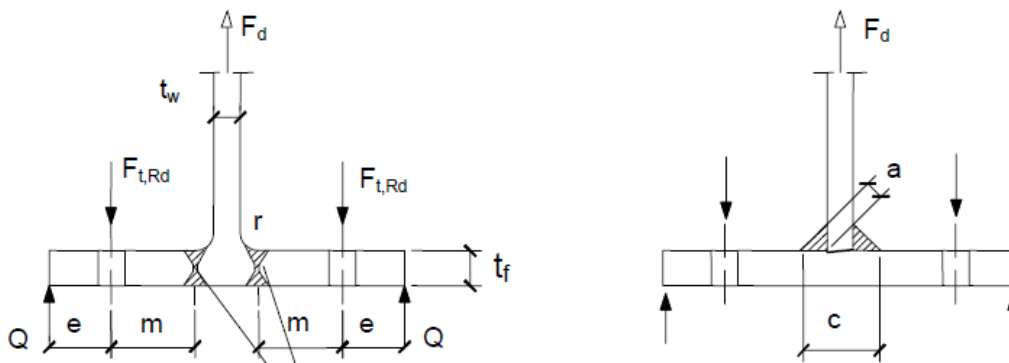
Casquillos en T. Disposición soldada (derecha) y disposición que corresponde al mismo elemento (izquierda).
